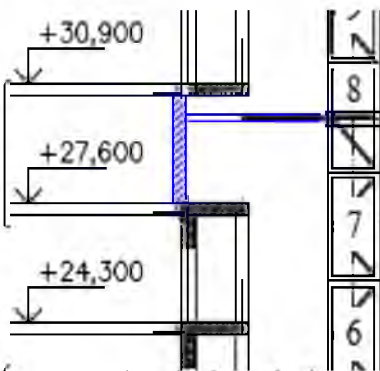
Кріплення баштового крану до жорстких конструкцій каркасу
